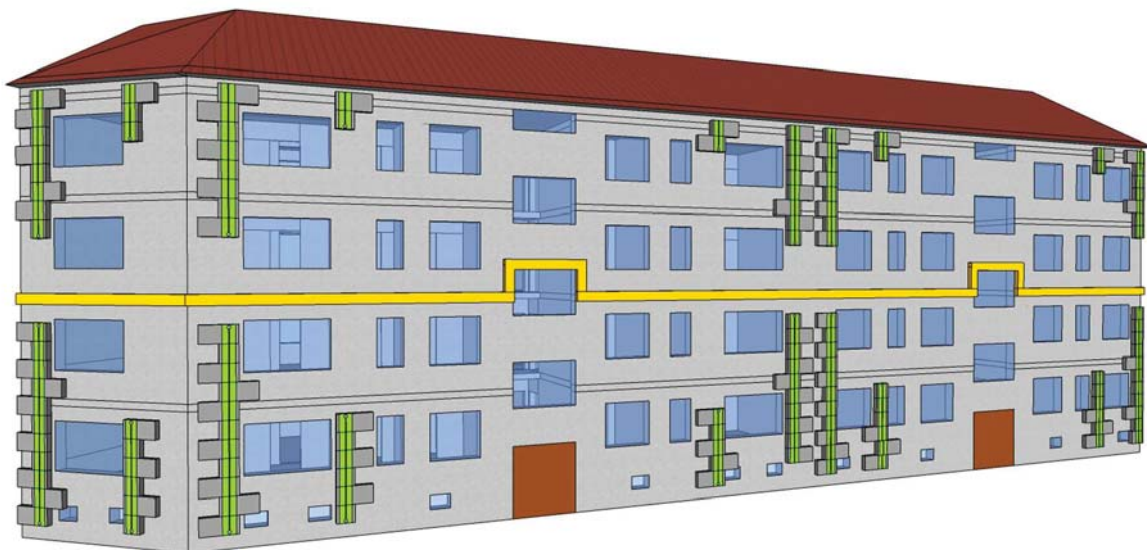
Lösung für die Luftkanalführung für GK4-Gebäude bei Anordnung eines umlaufenden Brandriegels mit fassadenintegrierter Zuluftkanalführung und Abluftkanalführung über bestehende Schachtsysteme, Anschluss zweier Geschosse über den Dachboden und den Keller
